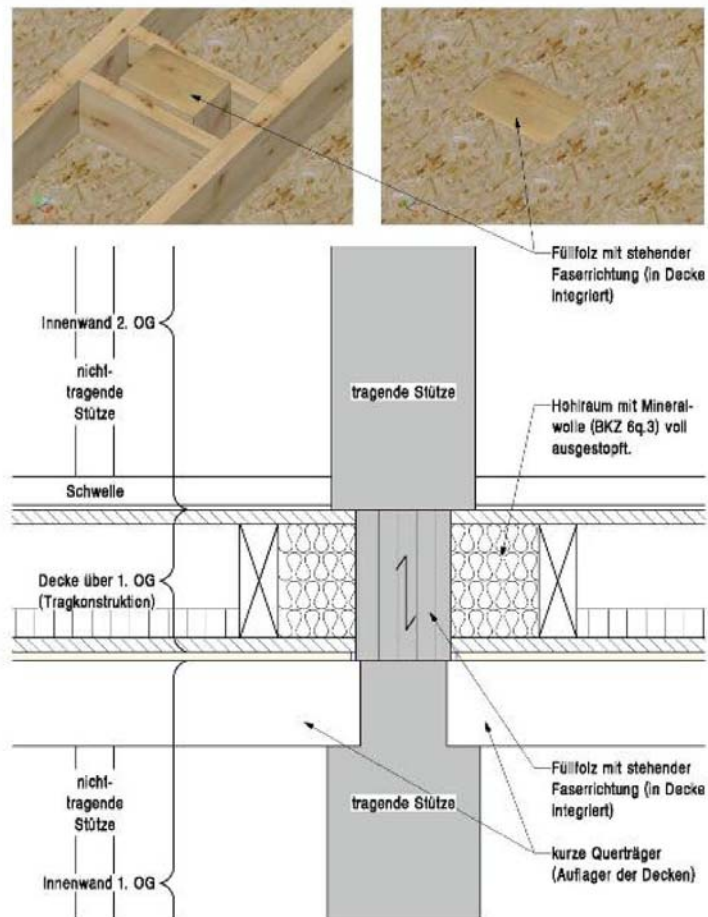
Die Lastabtragung durch die durchlaufenden Geschossdecken wird mit stehenden Hölzern, welche in den Deckenelementen eingebaut sind, gewährleistet.
